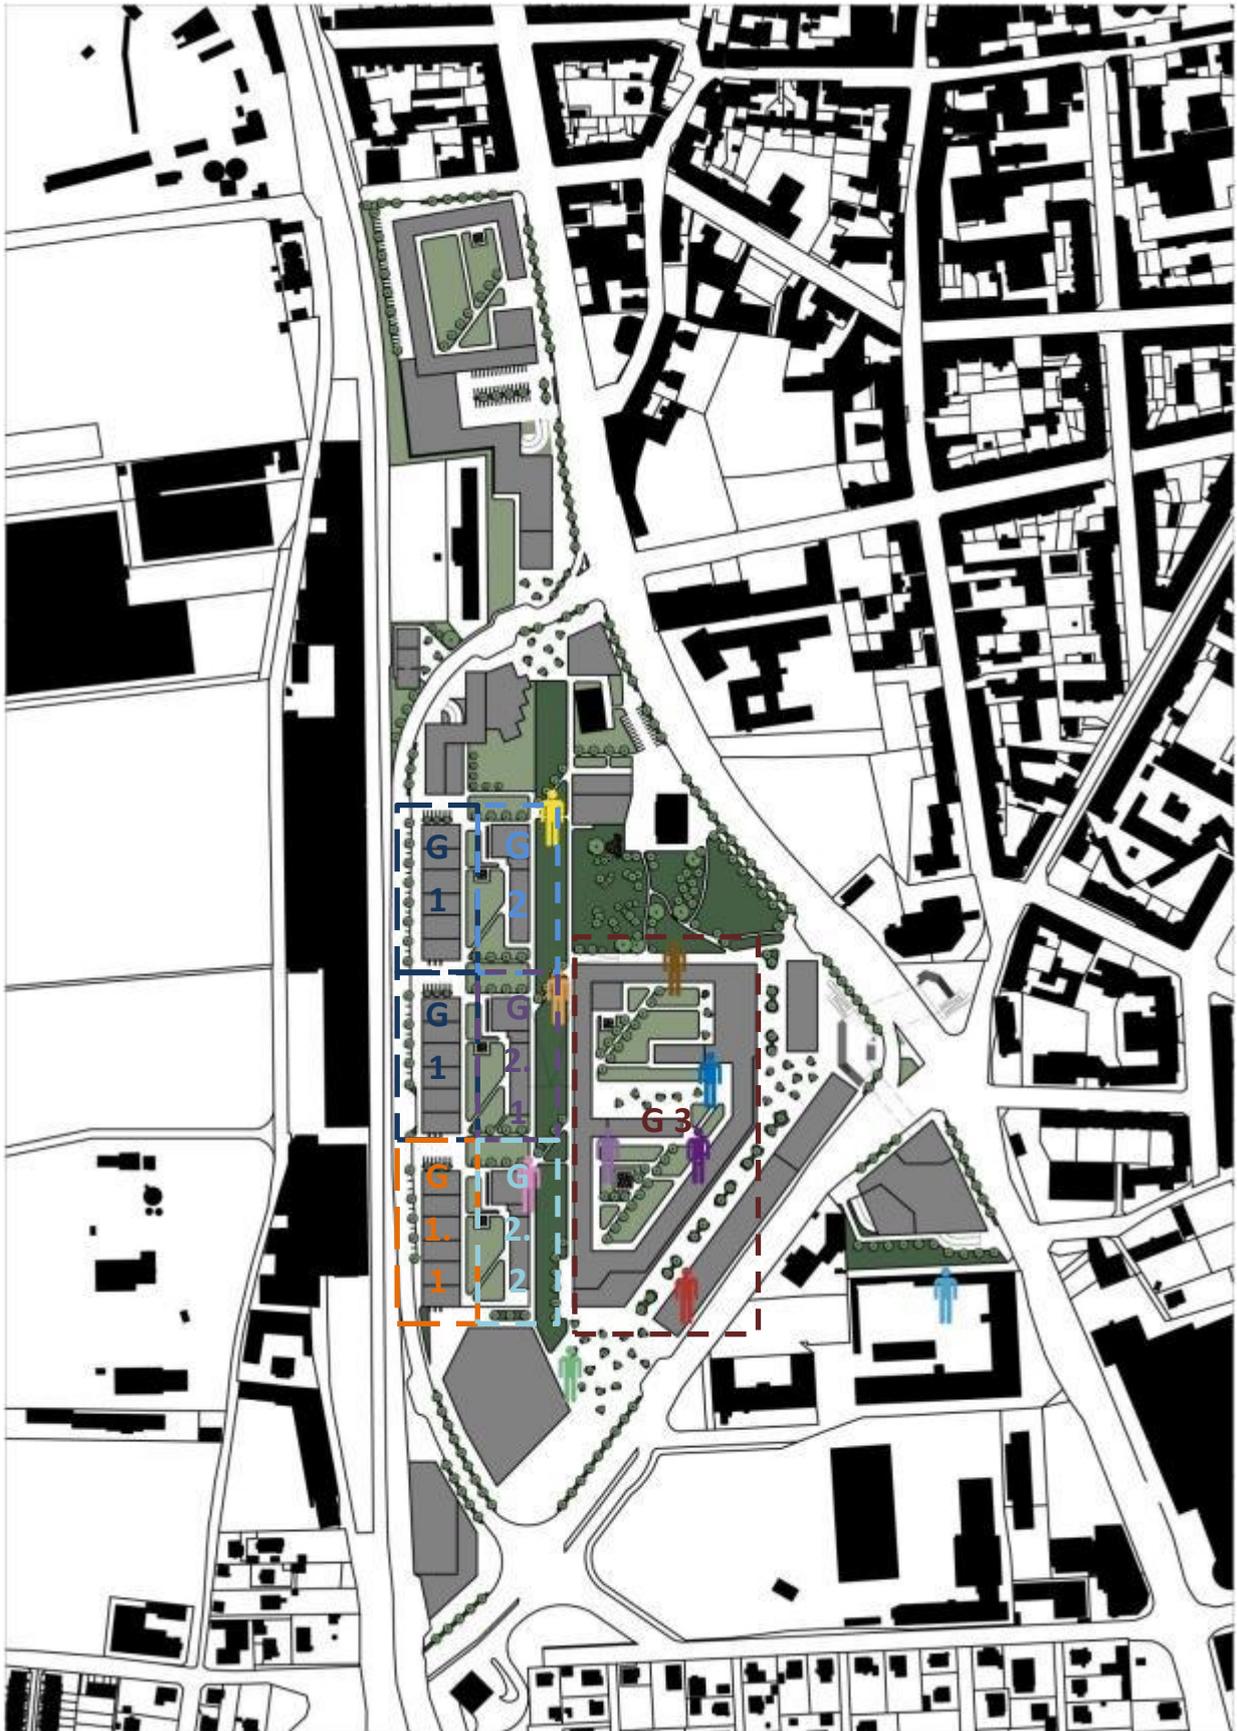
Lageplan mit Gebäude- und Abbildungskennzeichnung
